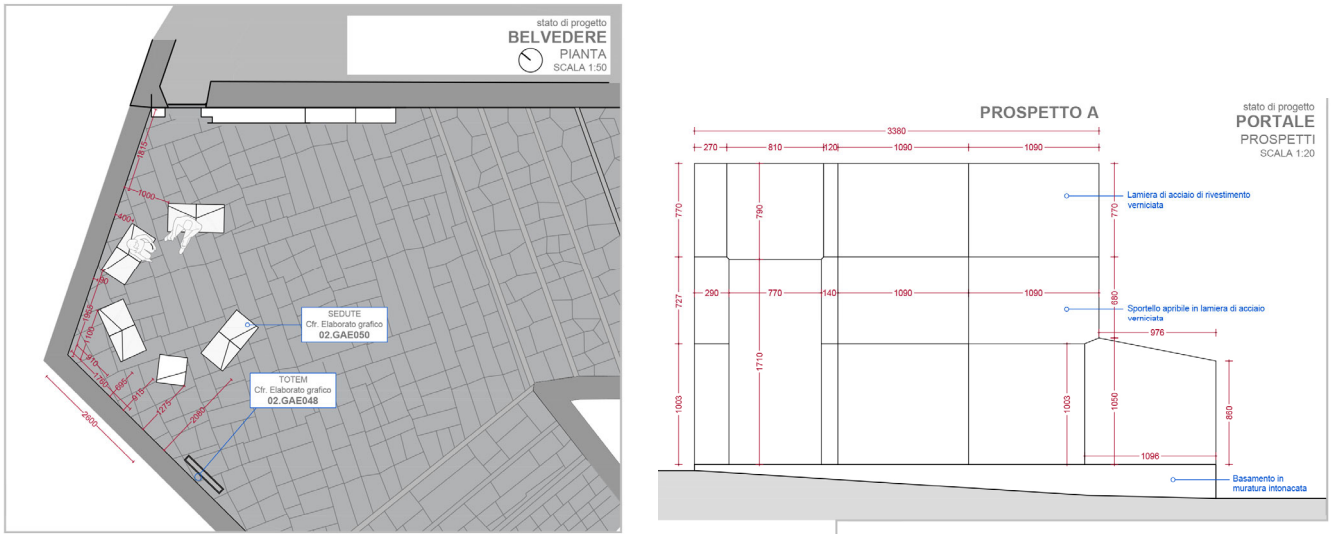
progetto – stralcio planimetrico e prospetto controparete
